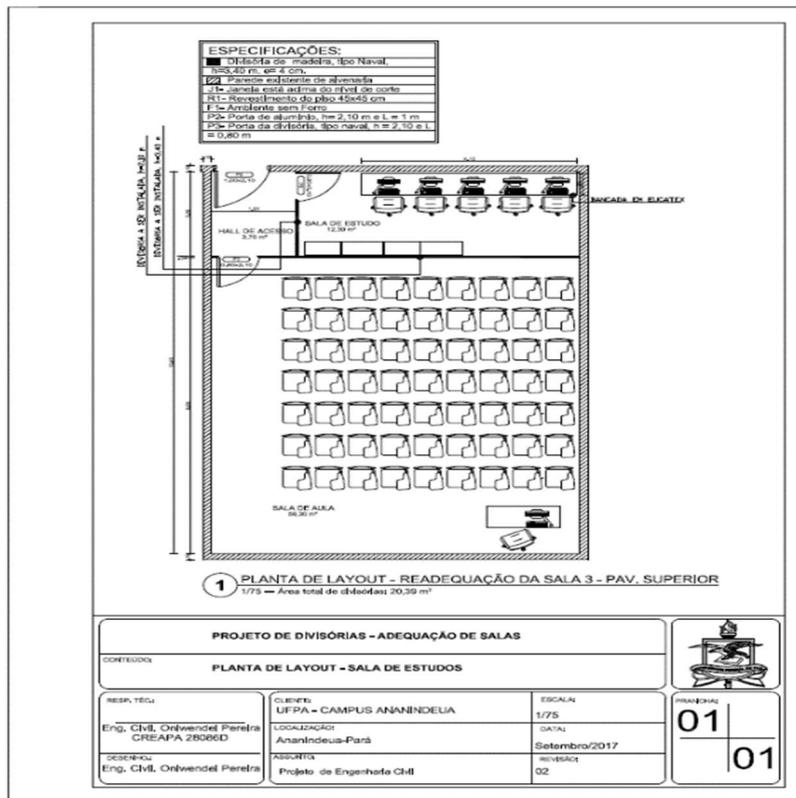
Planta baixa para implantação da sala de estudo, no bloco principal.
